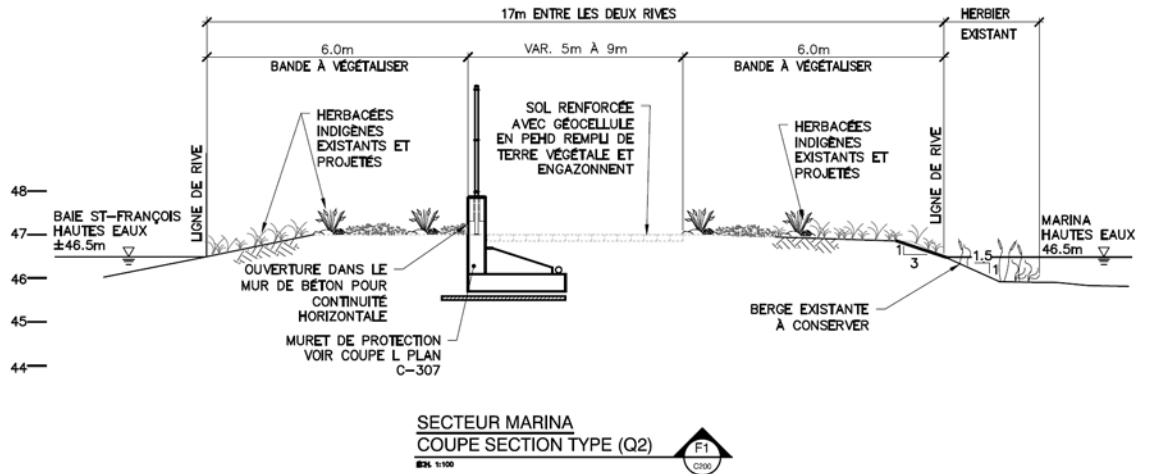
Coupe-type F1 – Langue de terre et muret de protection
